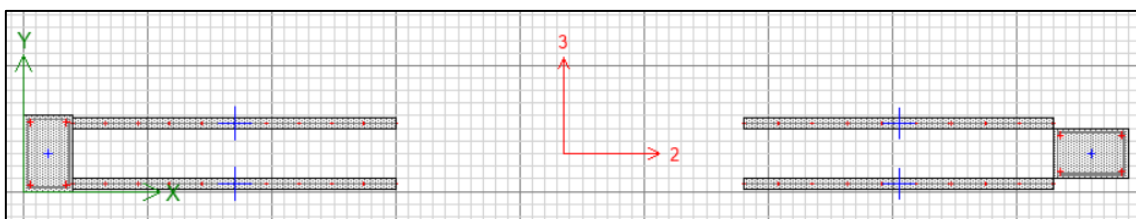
Armado de enchape con espaciamento, muro con ventana.
